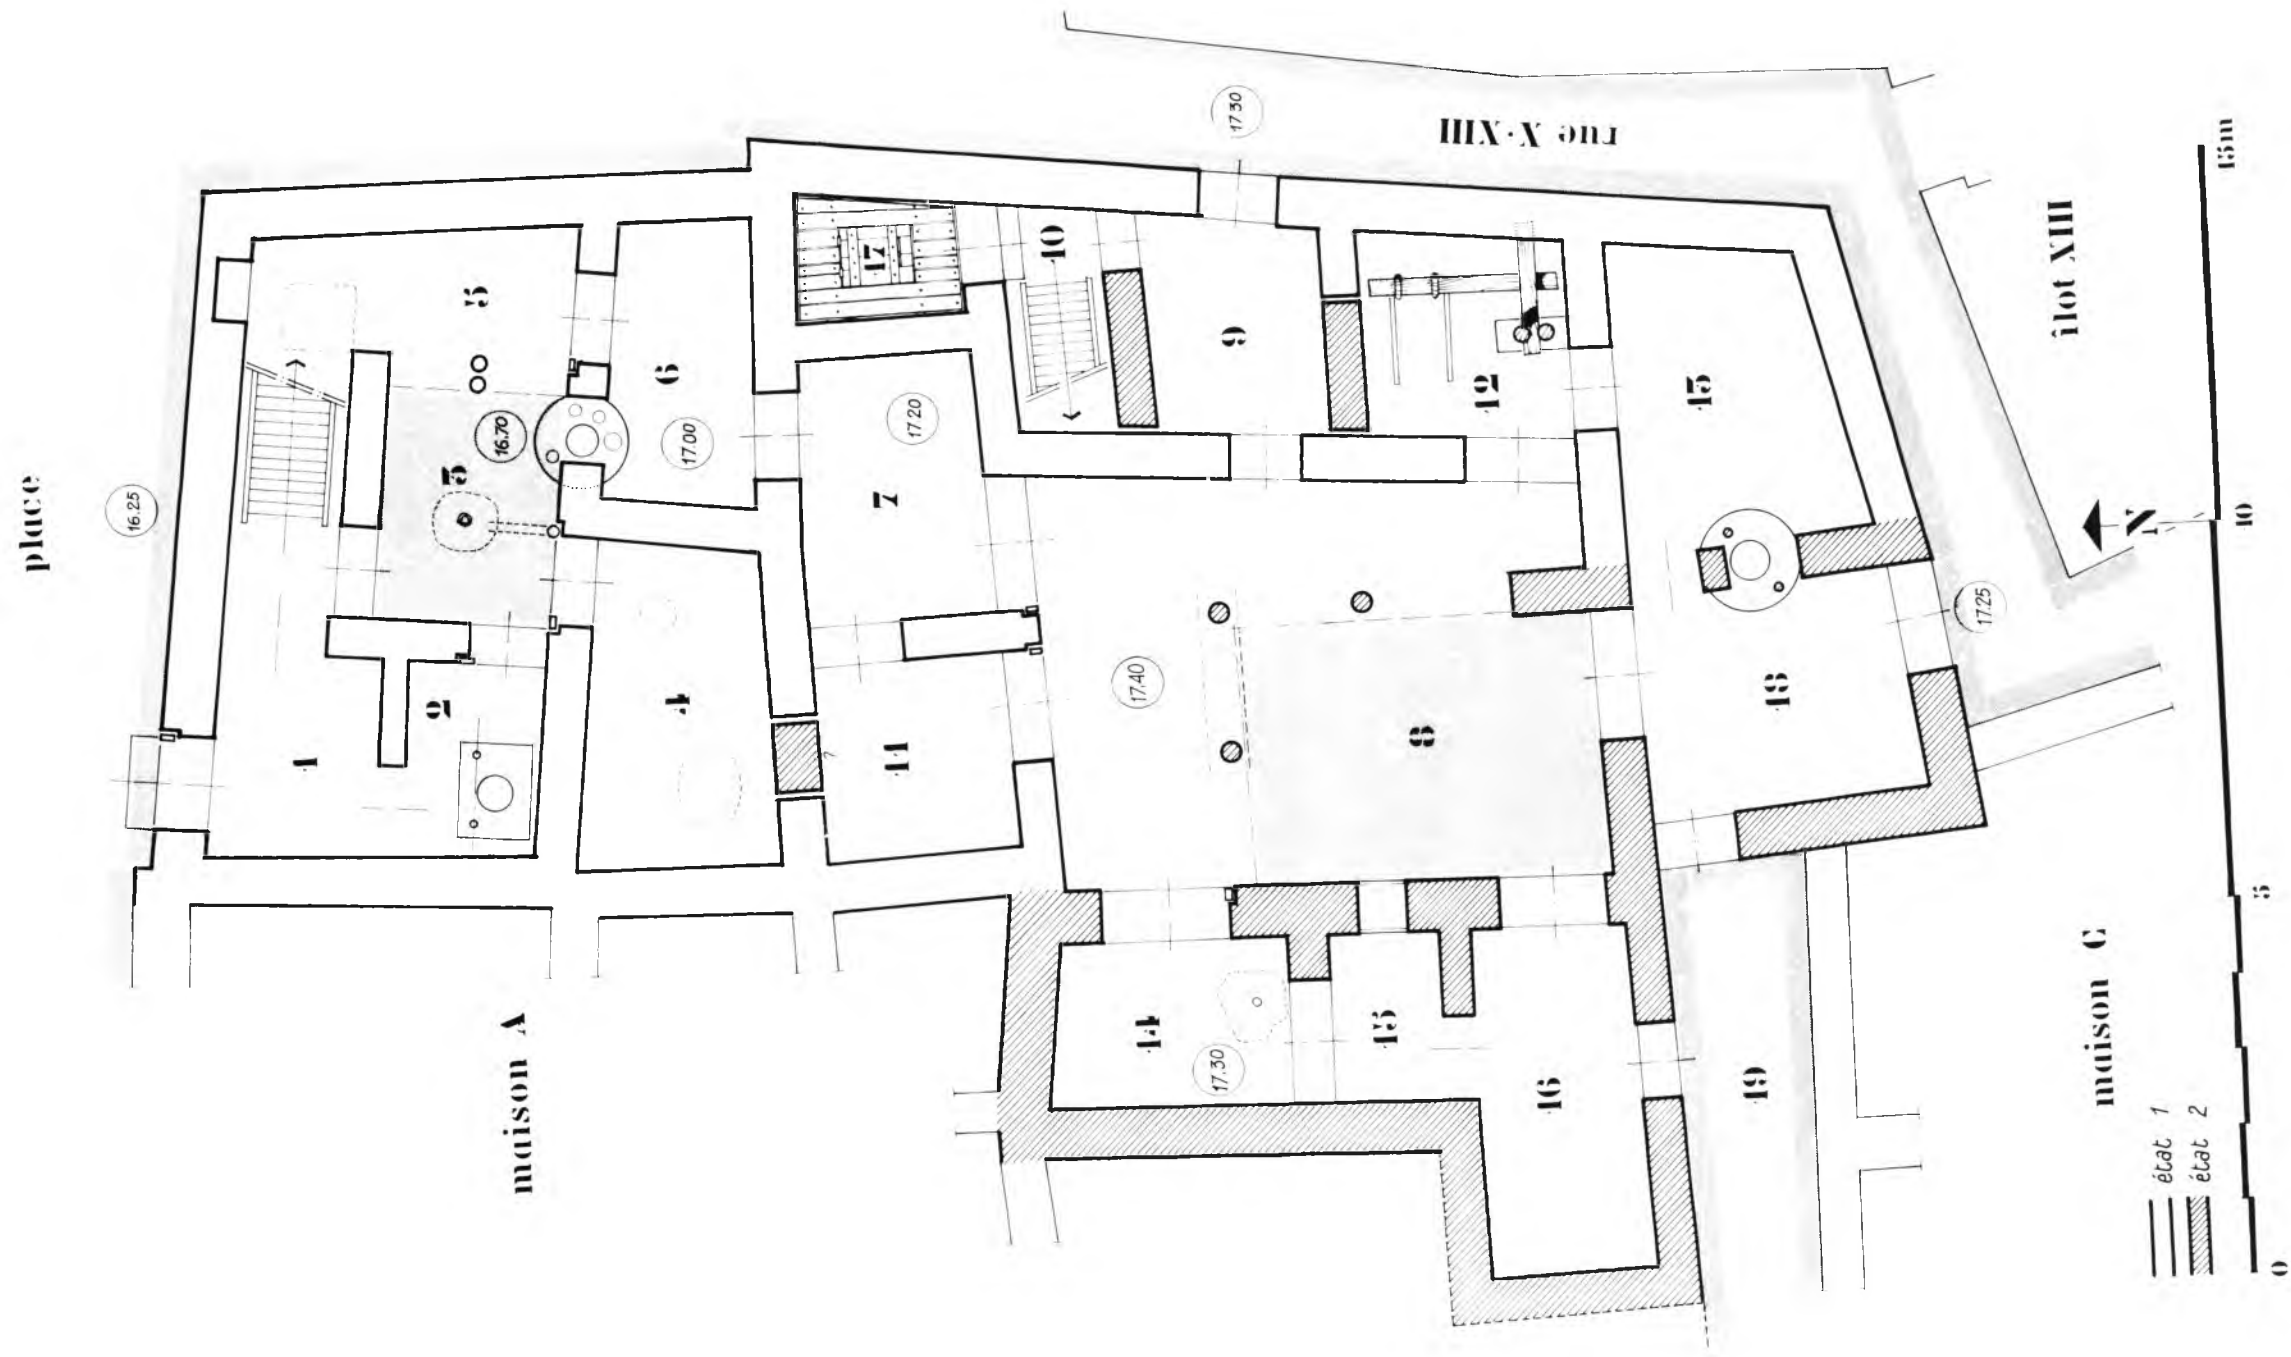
Ilot X : Maison B, plan restitué du rez-de-chaussée.
